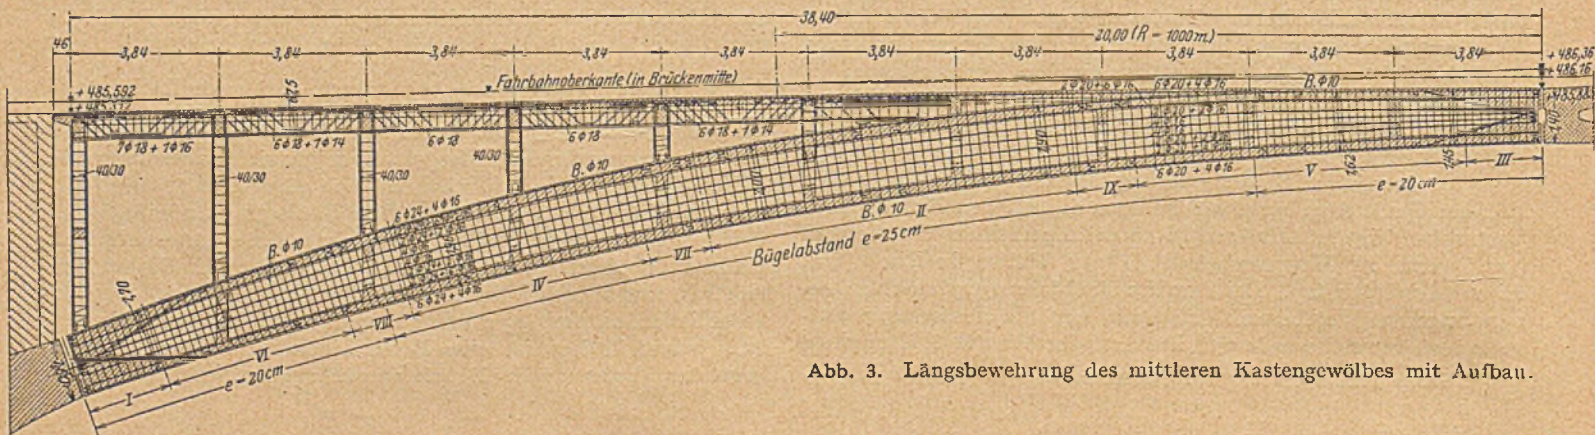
Längsbewehrung des mittleren Kastengewölbes mit Aufbau.
